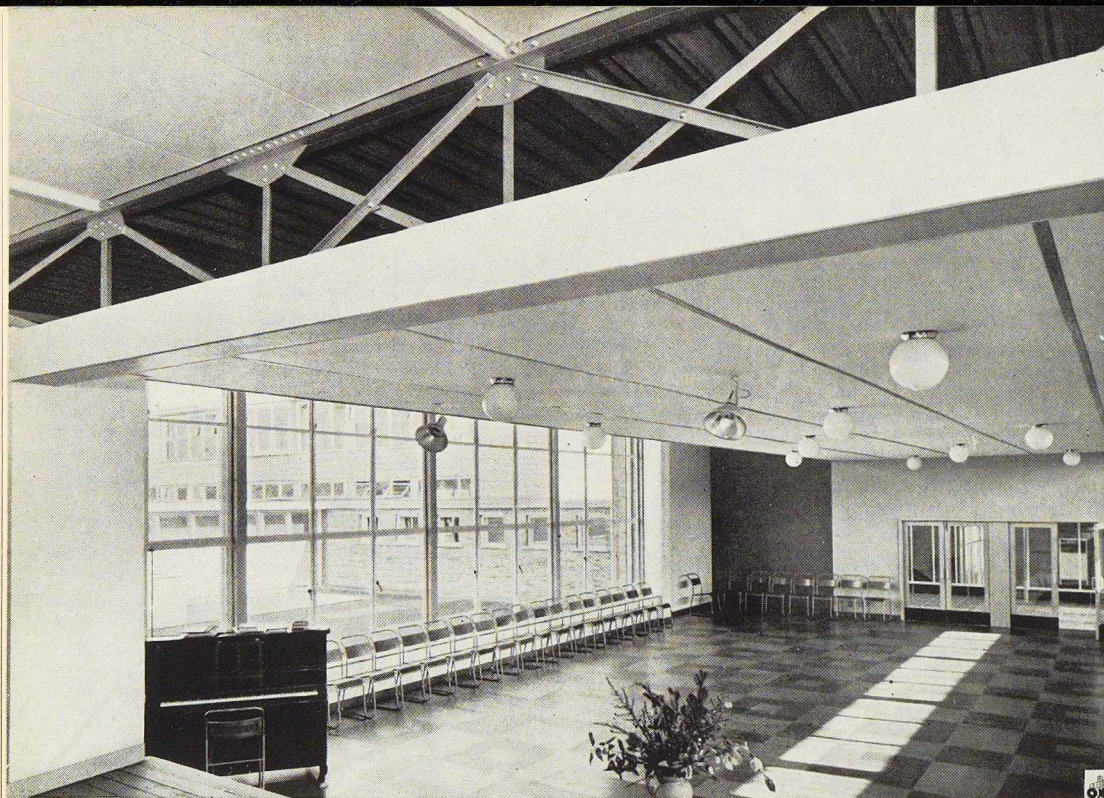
(ci-contre). Salle de réunion. Les poutres en treillis sont masquées par un faux plafond.
